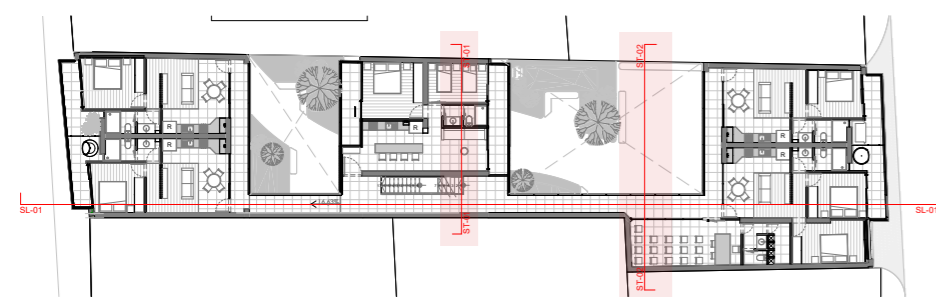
Planta de referencia para secciones. Fuente: Elaboración propia.
